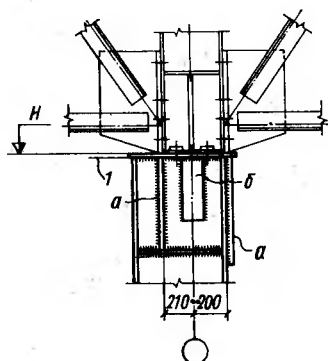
Оголовок колонны среднего ряда кранового здания с проходами вдоль подкрановых путей
